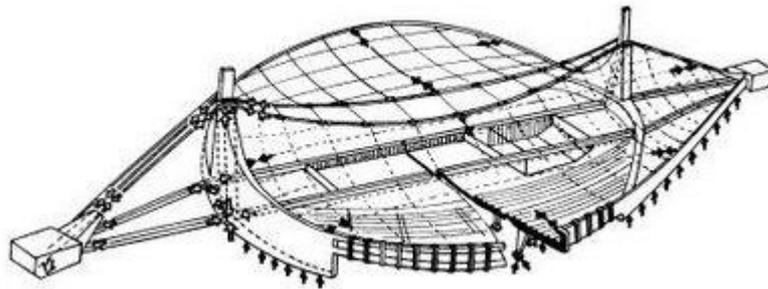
Struktur bangunan yang tampak menyerupai bentuk tenda
